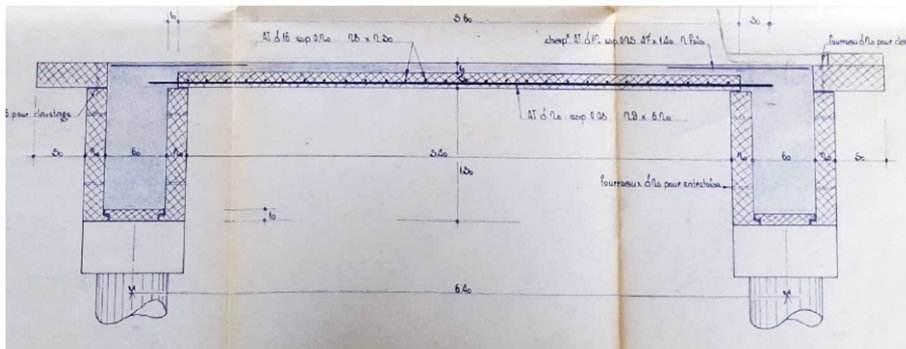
Plan de coffrage/ferraillage du tablier (source : capitainerie)
